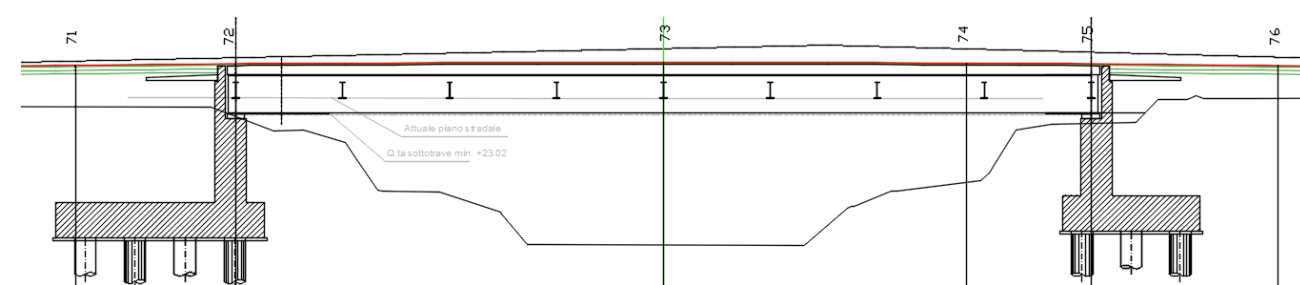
Sezione tipo di ponte sul Canale Navile
